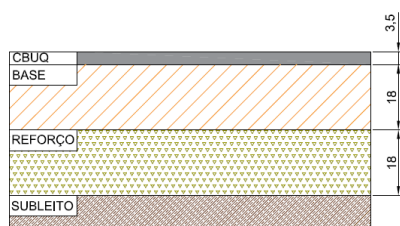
Camadas estruturais do pavimento hipotético após dimensionamento (espessuras em cm).
